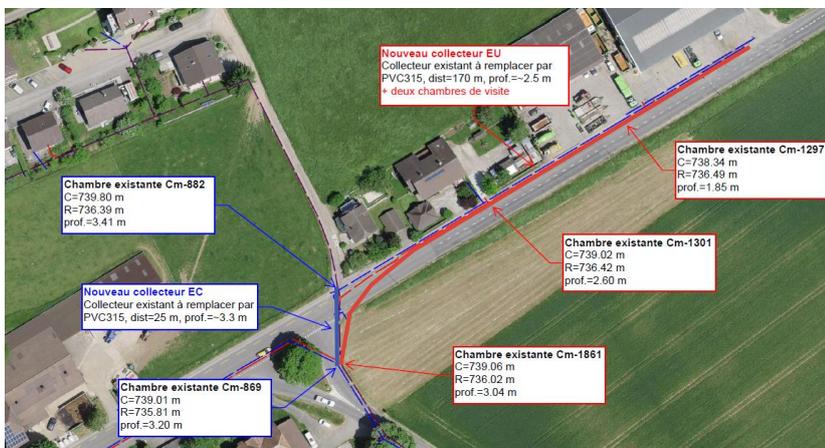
plan d'intention selon bureau Mauler SA (source SITN)
